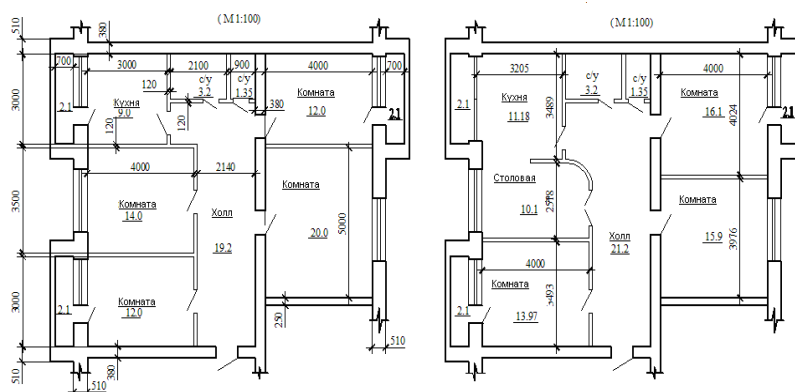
Вариант перепланировки четырёхкомнатной квартиры
